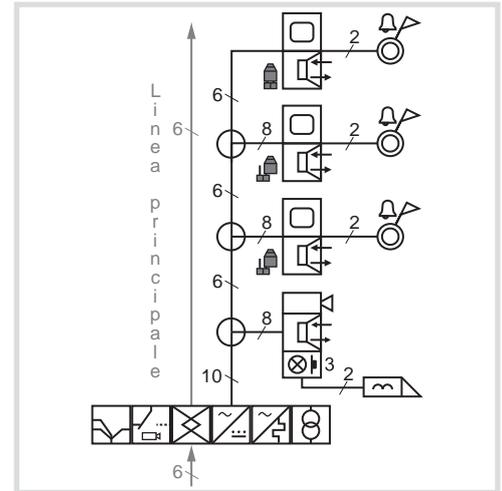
video 6D – Collegamento di una stazione da porta sui piani
